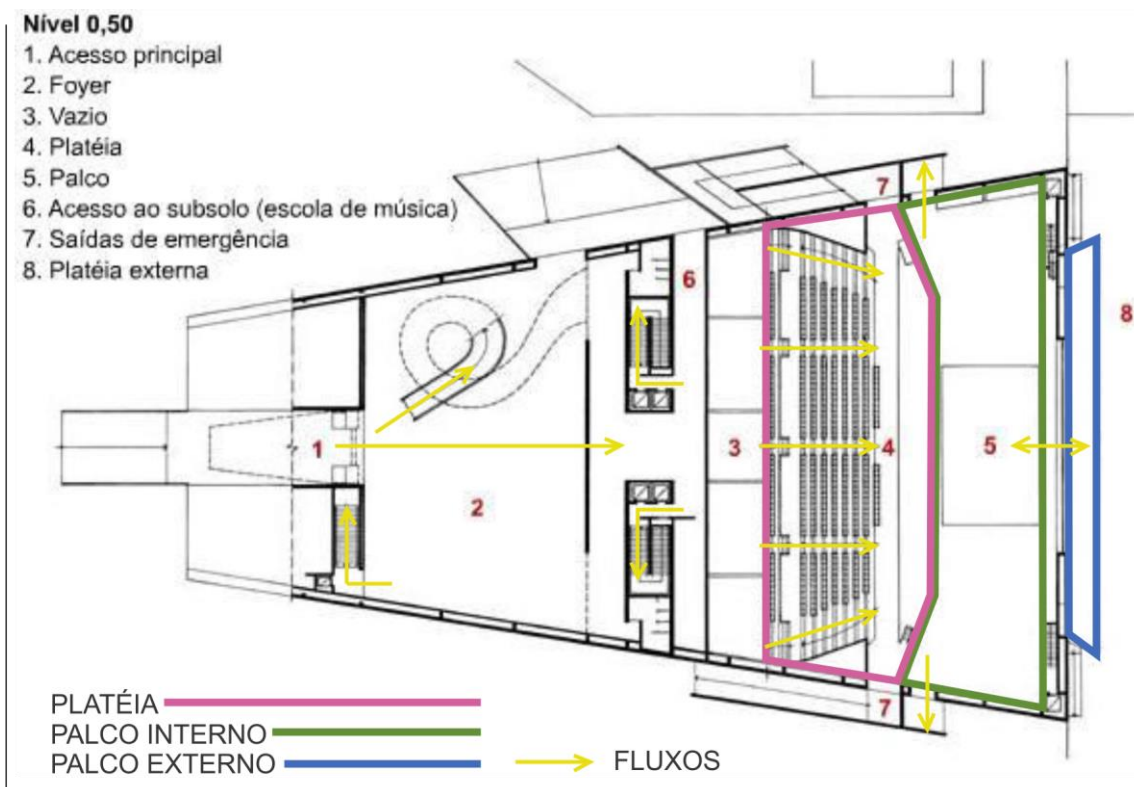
Planta baixa térreo, Auditório do Parque Ibirapuera
